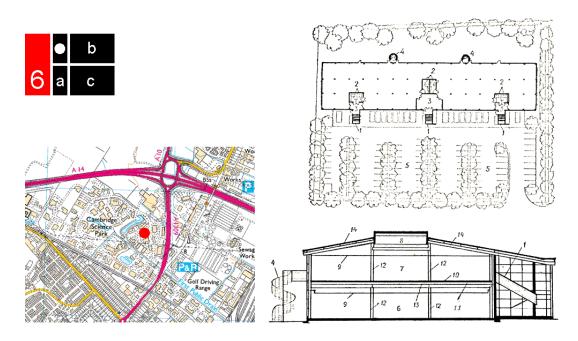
(а-с). Инновационный центр «Камтек» в научном парке Кембриджа - многопрофильное здание: а) схема размещения здания в парке; b) схема плана здания; c) схема поперечного разреза по зданию (1 – лестница со стороны главного фасада, 2 – сантехническая кабина, 3 – вестибюль, 4 – аварийная запасная лестница, 5 – автомобильная стоянка, 6 – первый этаж, 7 – второй этаж, 8 – надстройка для установок инженерного обеспечения, 9 – акустический потолок, поднятый (плавающий пол), 11 – плита перекрытия, 12 – трубчатая колонна, 13 – балка перекрытия, 14 – балка покрытия)
